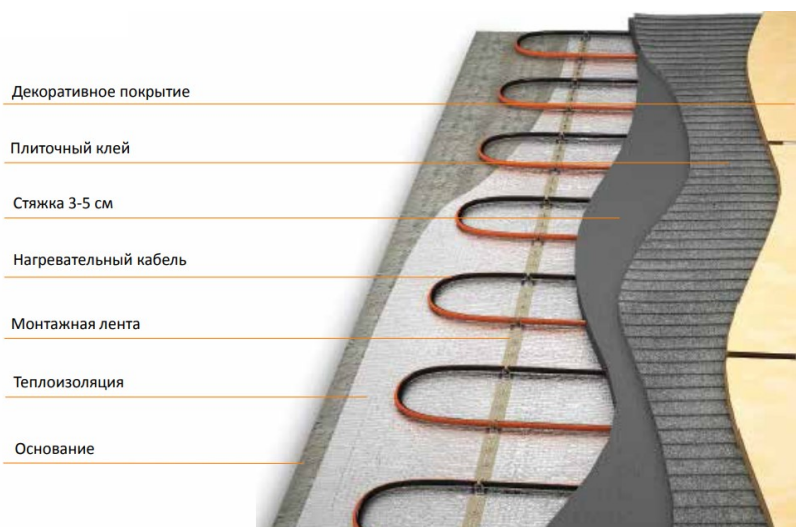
Конструкция перекрытия для монтажа электрического теплого пола в стяжку
